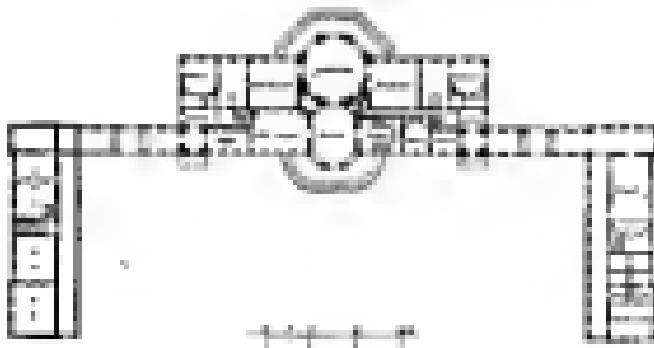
Architektonische Baubeschreibung, Grundriss nach dem in der Kartäuslichkeit in Rom befindlichen Original-Dokument.
